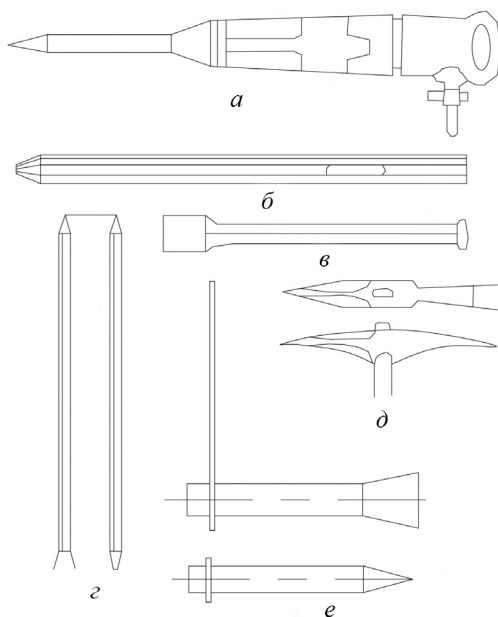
Инструменты для разборки каменной кладки и пробивки отверстий:
